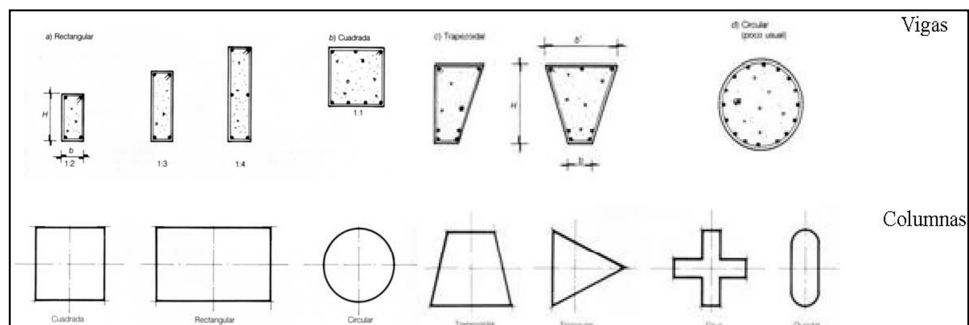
Secciones transversales en concreto armado (Construaprende, 2007).
